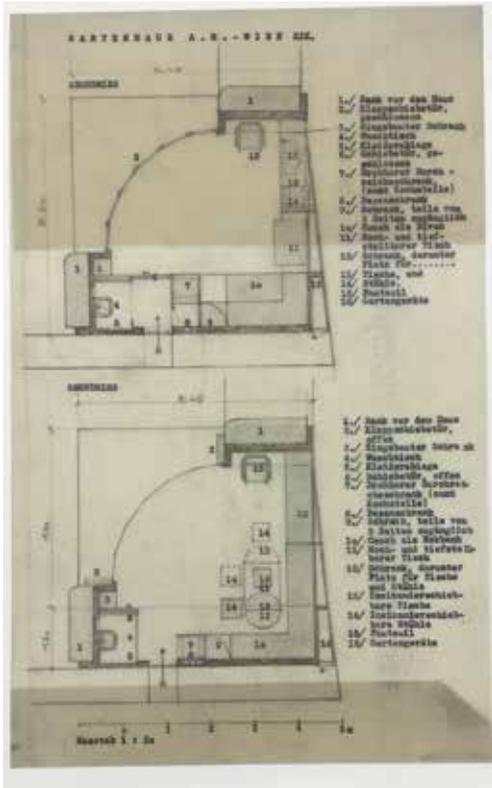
Gartenhaus Moller, Grundriss, 1931, BHA.
